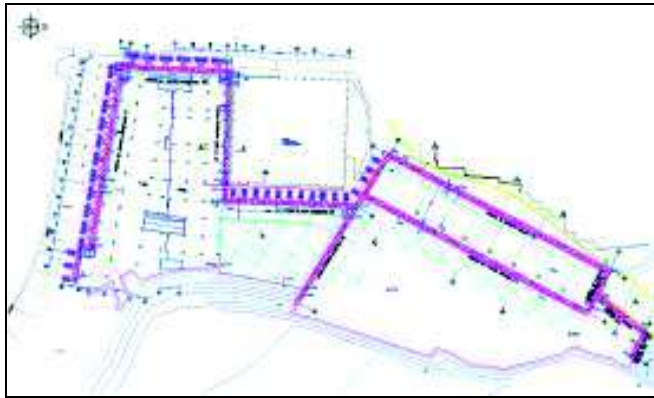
Planta general de las cortinas autoestables y vinculadas.
